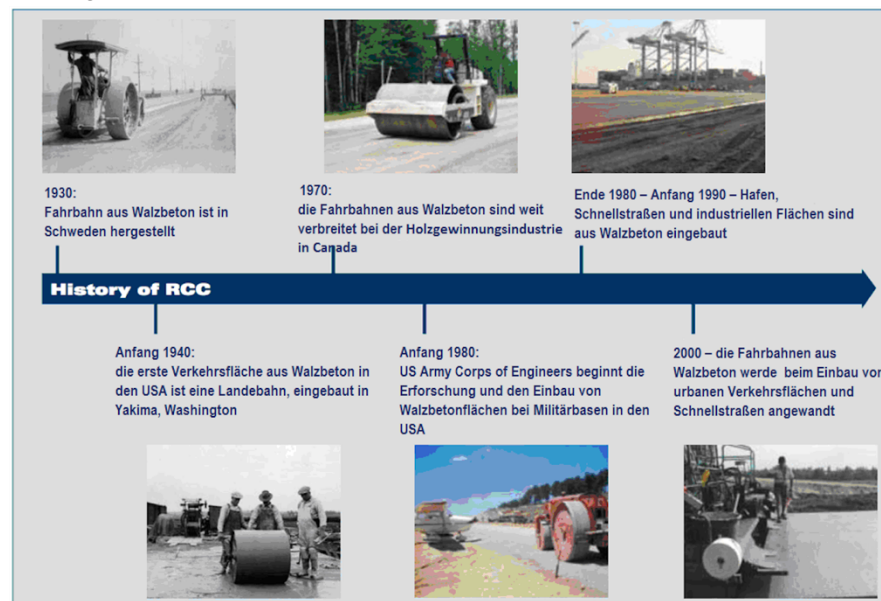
Die Entwicklung des Straßenwalzbetons [1]
